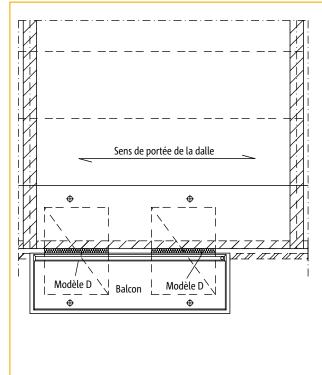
Balcon /loggia en tant que partie de la construction de plancher
